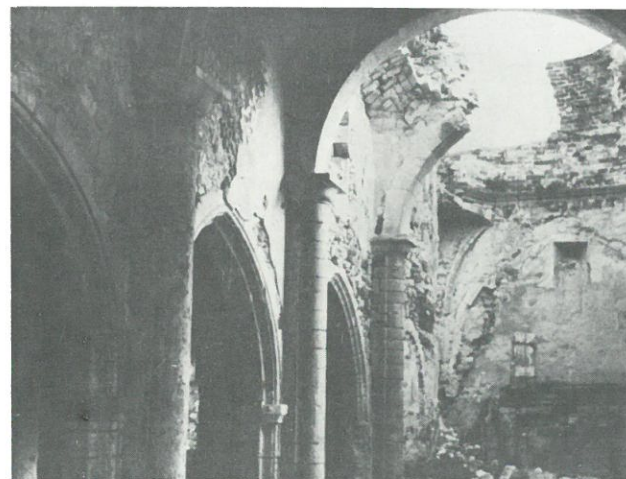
Gli effetti sulle strutture della Chiesa provocati dagli smottamenti in atto
